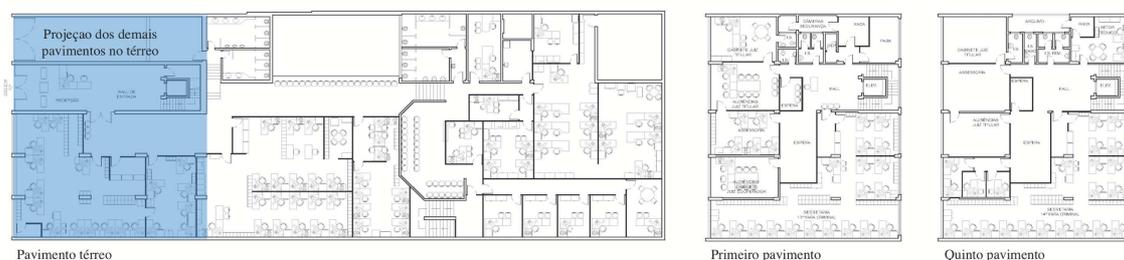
Planta baixa dos pavimentos da VIJ TJMG. Fonte: TJMG.
